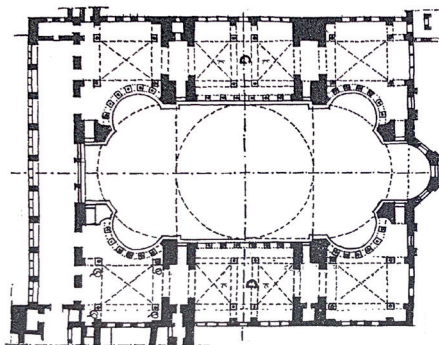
Planta Santa Sofía de Constantinopla (Thunnissen)
